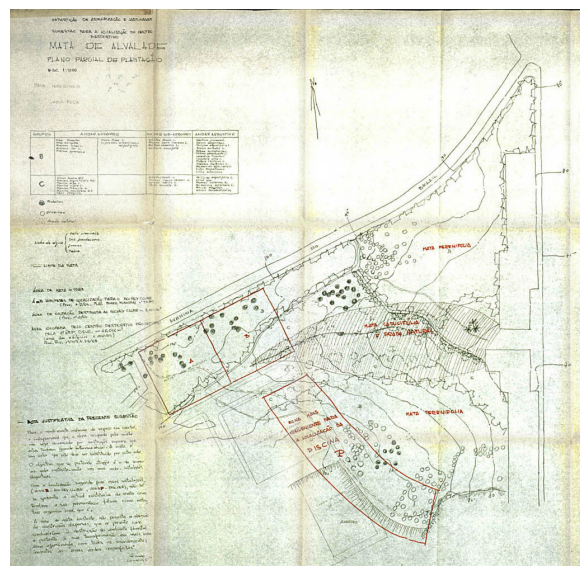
Mata de Alvalade. Plano parcial de plantação. Sousa da Câmara, 1965.
